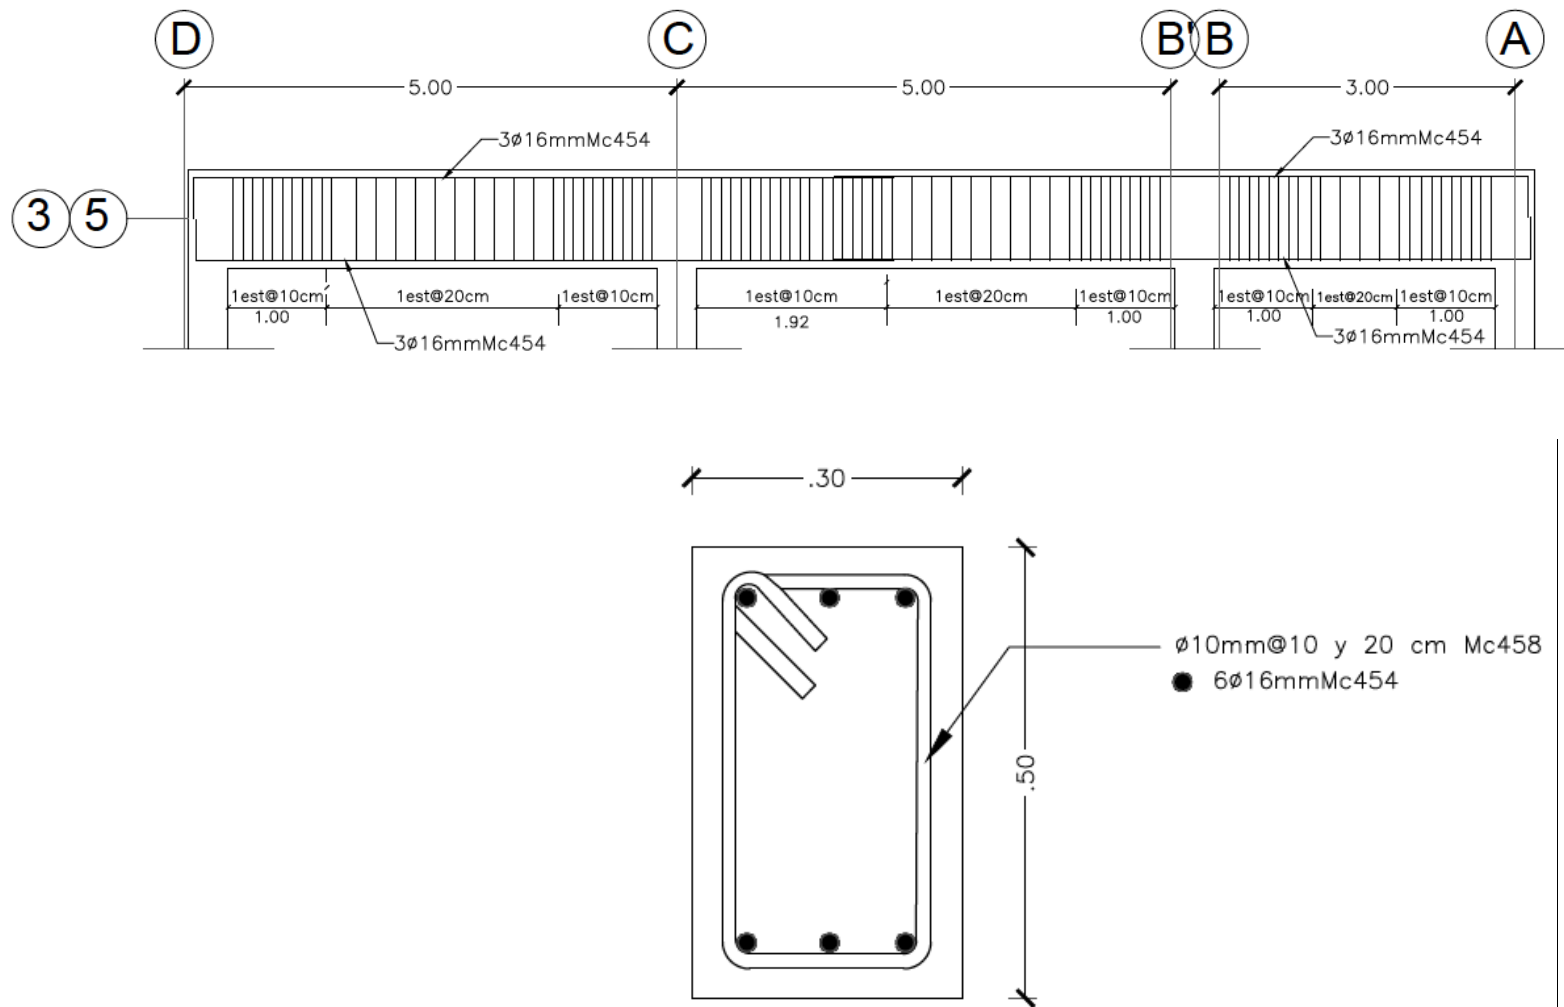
Detalle viga 30 cm x 50 cm, armado de 6 ϕ 16
